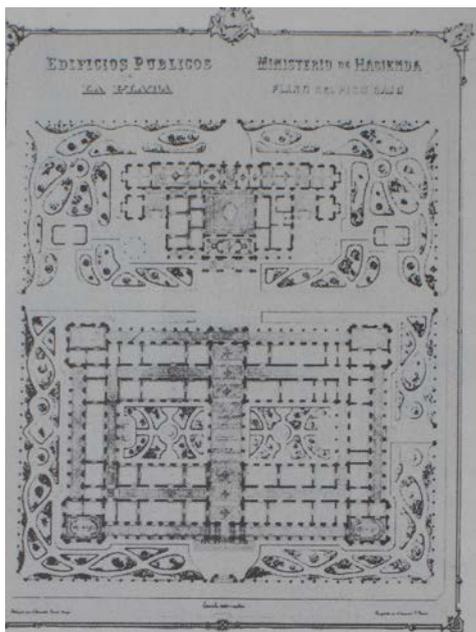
Ministerio de Hacienda. Avenida 7 entre 45 y 46. La Plata. Planta
